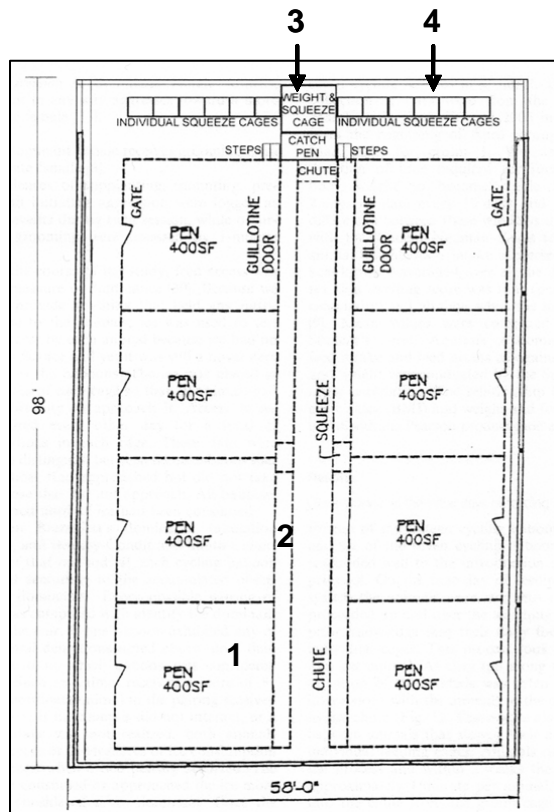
Grundriss der Haltungsbedingungen (nach Schlabritz-Loutsevitch et al. 2004a).
